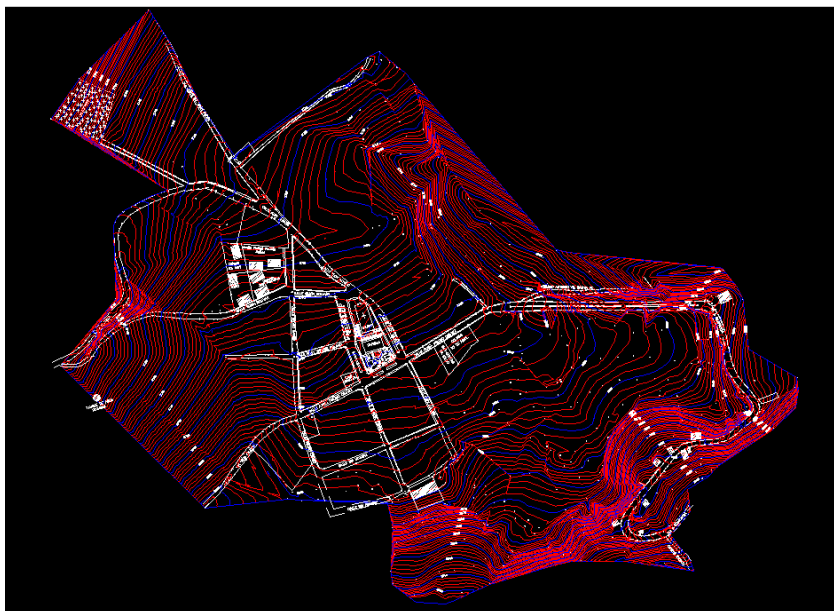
Imagen AutoCAD de la parroquia Santa Fé
